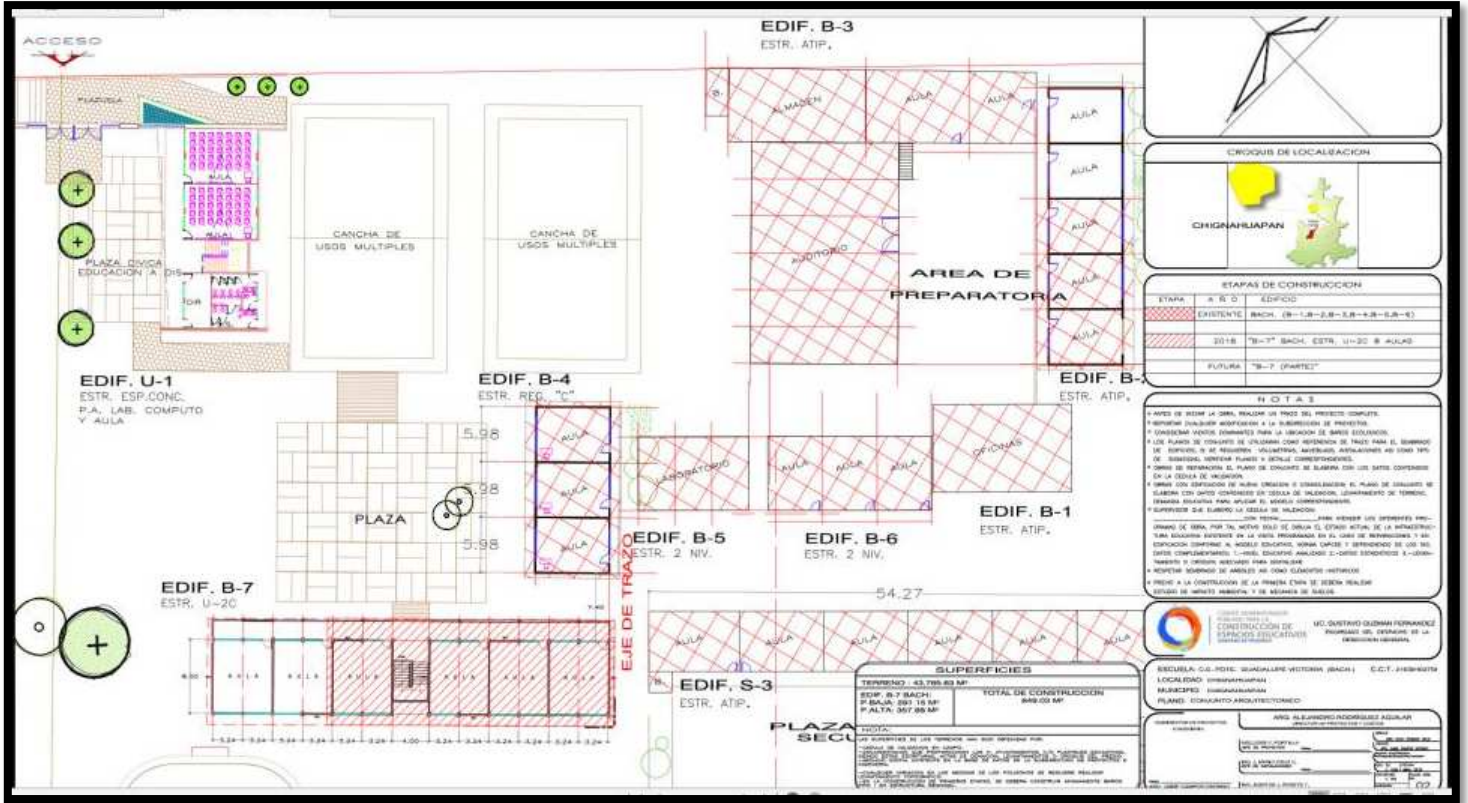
Plano de conjunto 1. Fuente: (Capcee. 2018).
